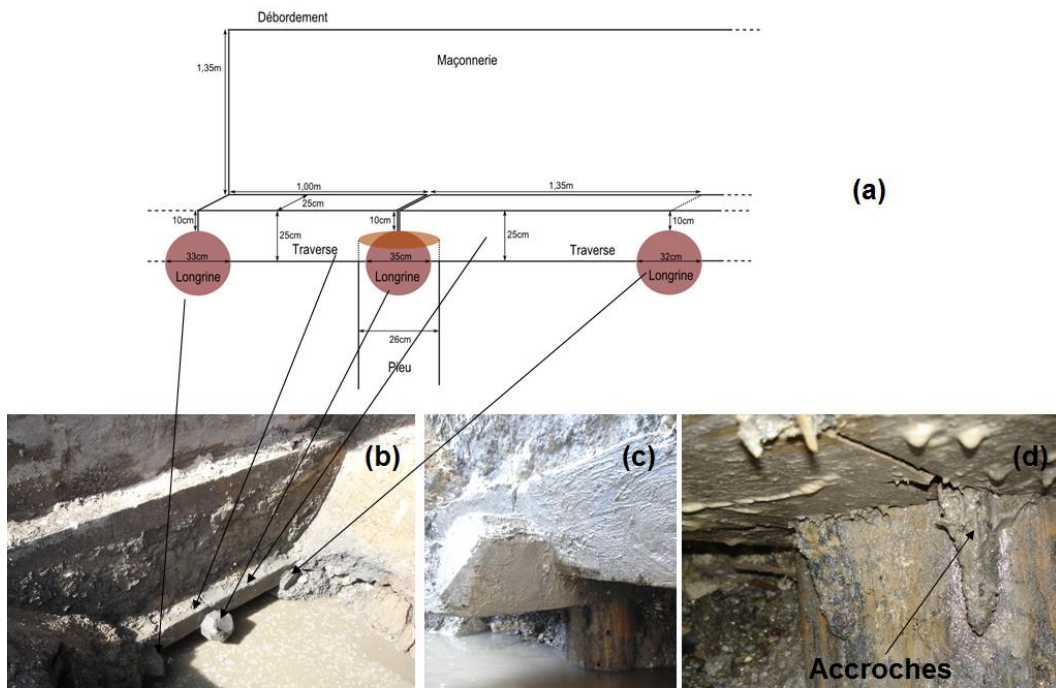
Vue de face de la fondation (a) et photos prises sur sites (b, c et d)
